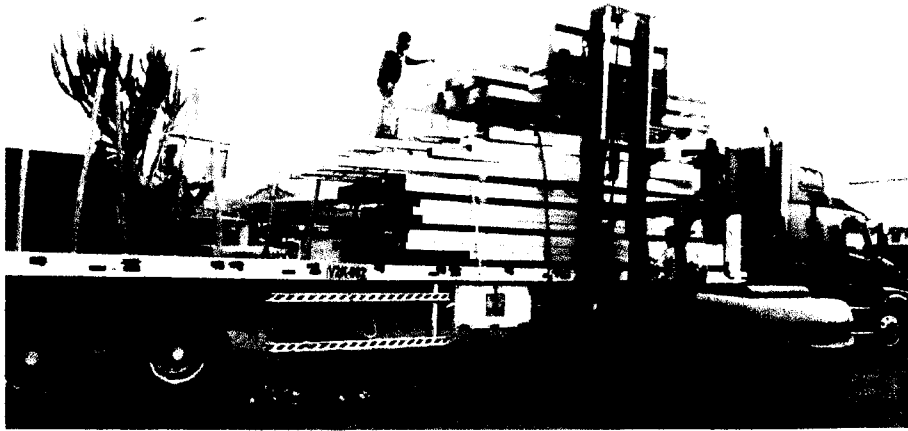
Cargando la estructura metálica al camión para el transporte hacia obra
